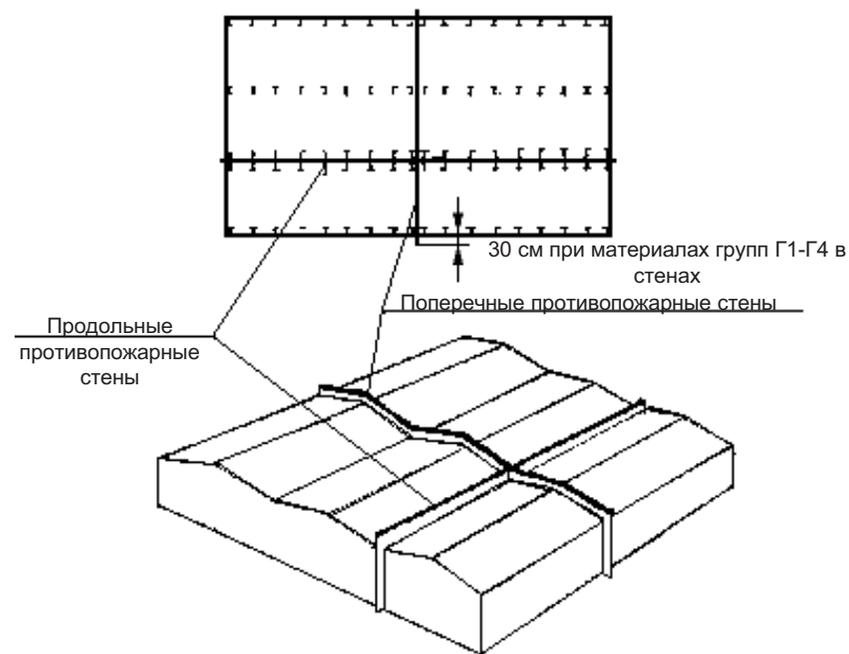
Разделение зданий на пожарные отсеки противопожарными стенами
